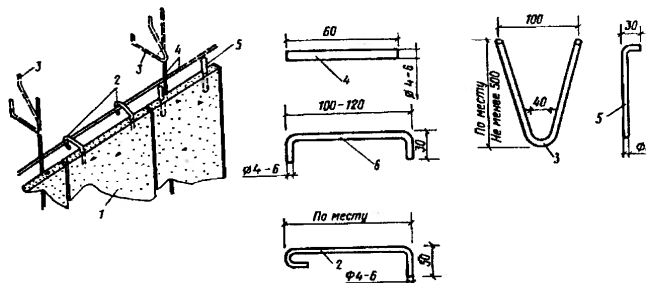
Крепление к стене облицовочных плит из природного камня: 1 – облицовочная плита; 2 – крюк; 3 – петля, заложённая при кладке стены; 4 – рабочая арматура (вертикальная и горизонтальная); 5 – штырь; 6 – скоба для соединения угловых плит
